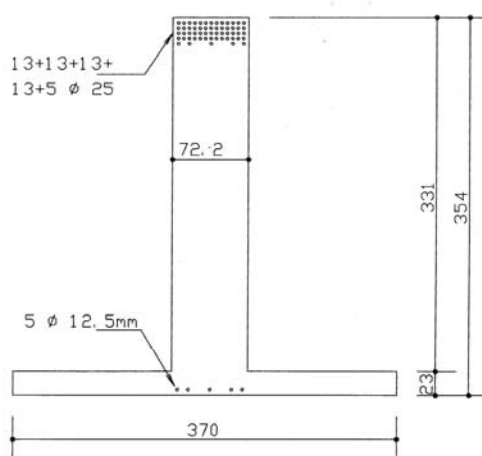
Croquis da seção transversal da seção mais solicitada da viga da cobertura
